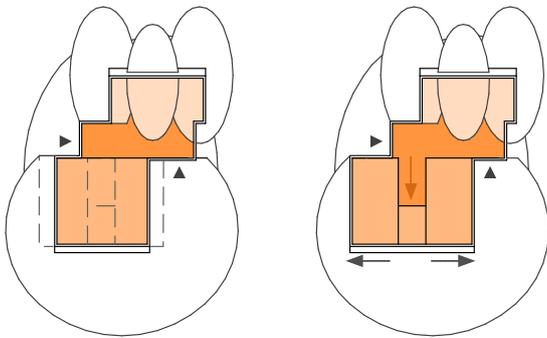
Grundrisse Schritt 1 und 2
